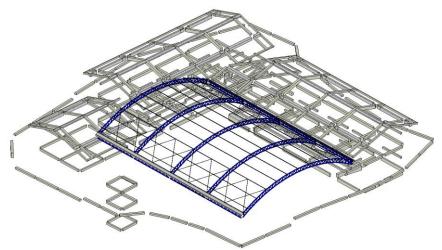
Categoría Armazón Estructural aislada del modelo federado de Estructuras
